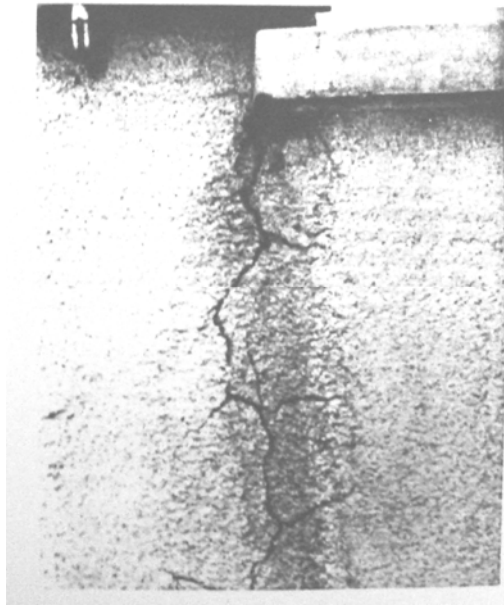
O fluxo de água interceptado no peitoril da janela escorre lentamente ao mesmo, provocando a fissuração da argamassa de revestimento. (Fonte: THOMAZ)
